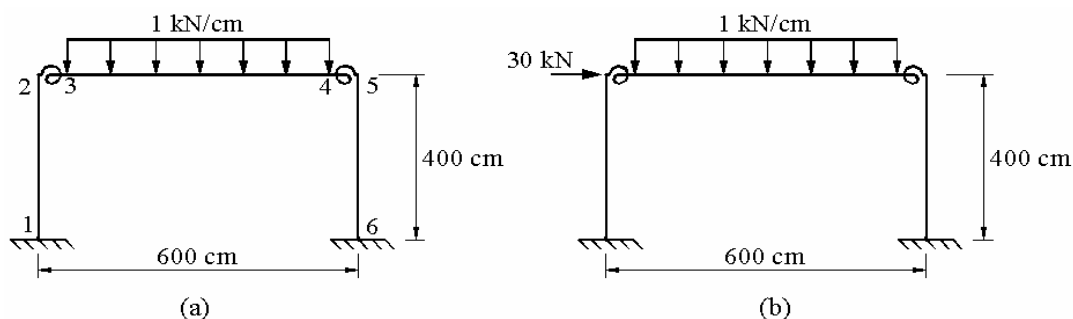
Pórtico de um andar e um vão com ligações semirrígidas
